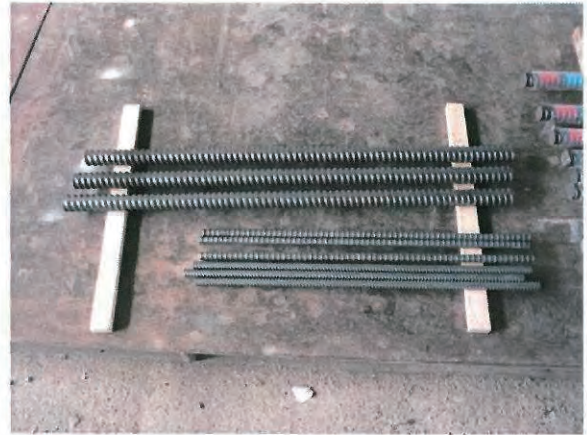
試験体製作状況（鉄筋、塗装なし）
